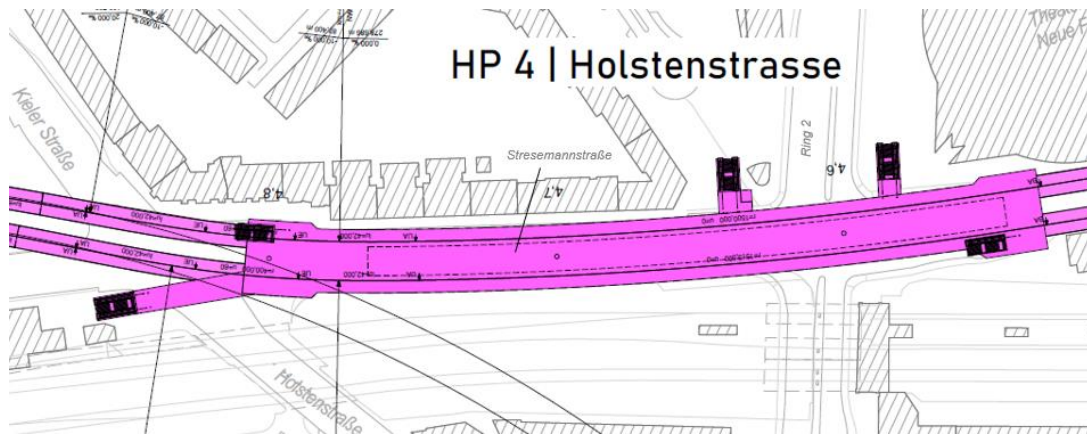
Hp Holstenstraße Var. I – Lageplan
